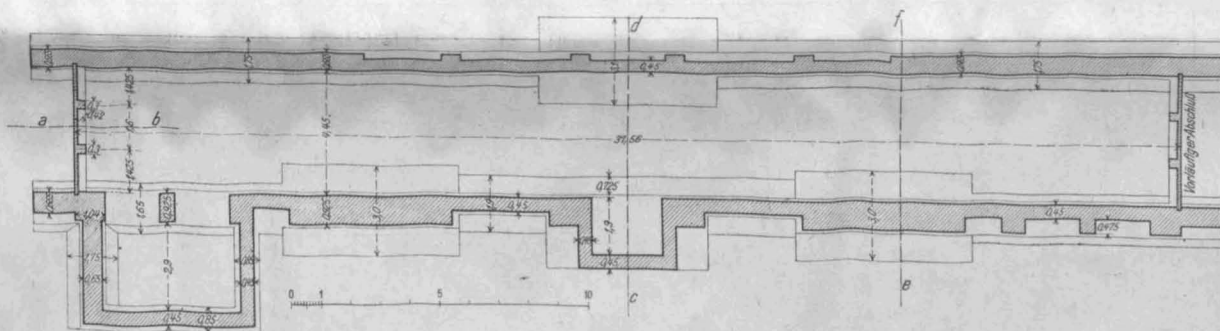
Grundriß des Bücher-Verteilungs-Tunnels unter dem Lesesaal-Gebäude.
